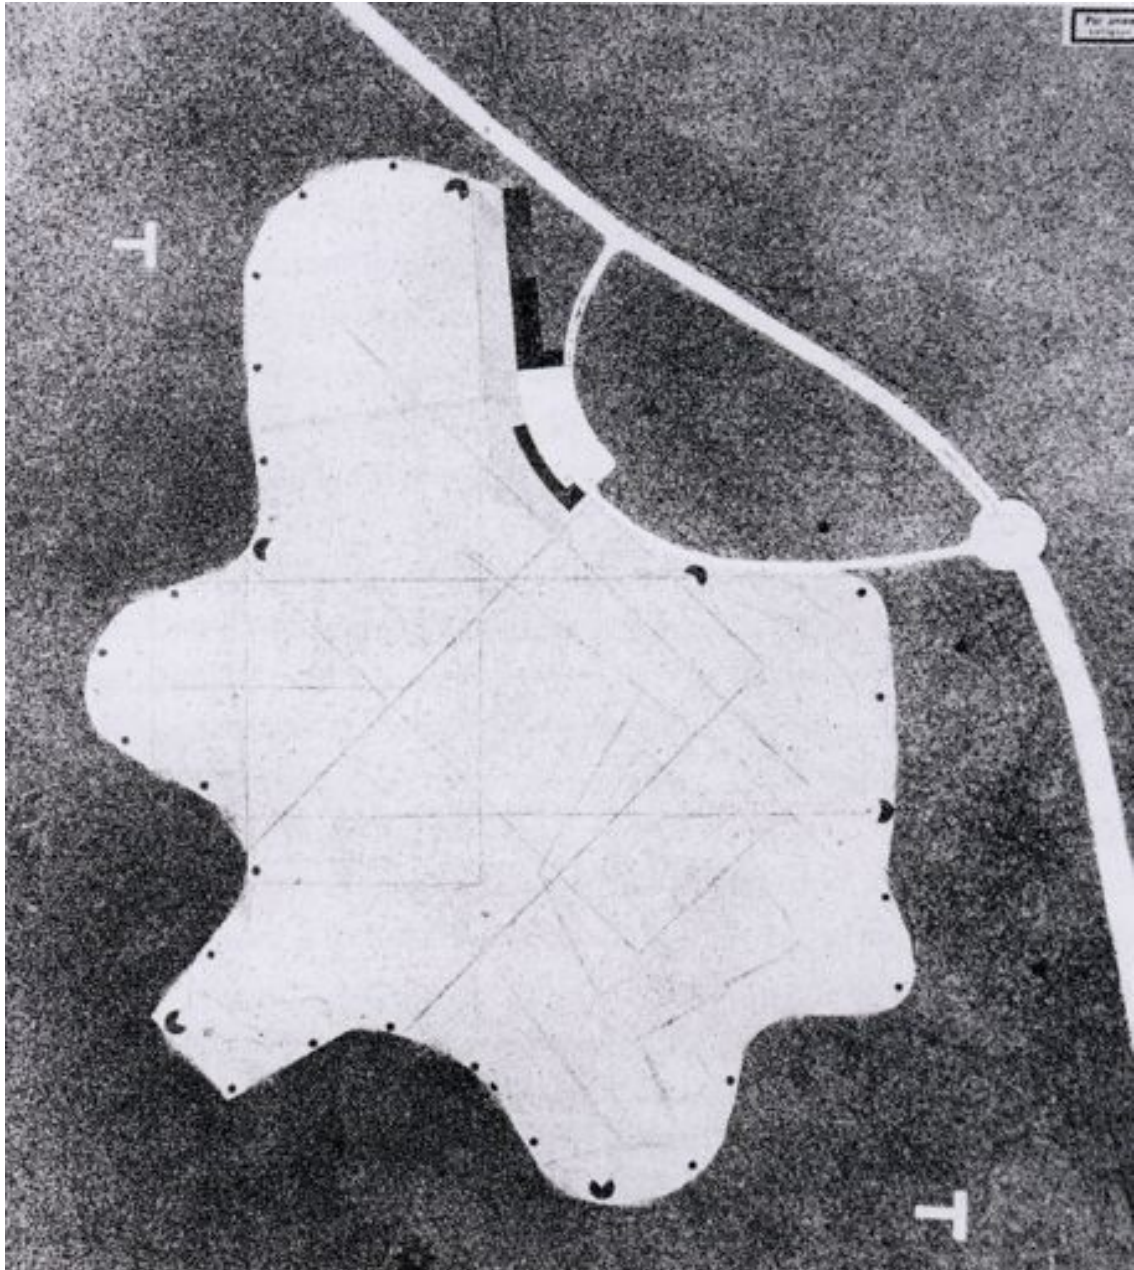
Paul Hedqvist; Förslag till dispositionsplan. Norrriktningen uppåt.
